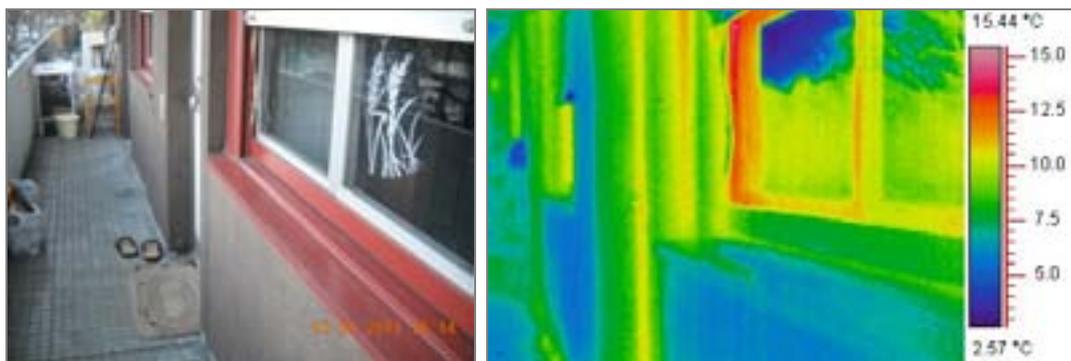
Immagini di rilevamento del Virgolone - Infissi unità tipo A3 piano primo.
